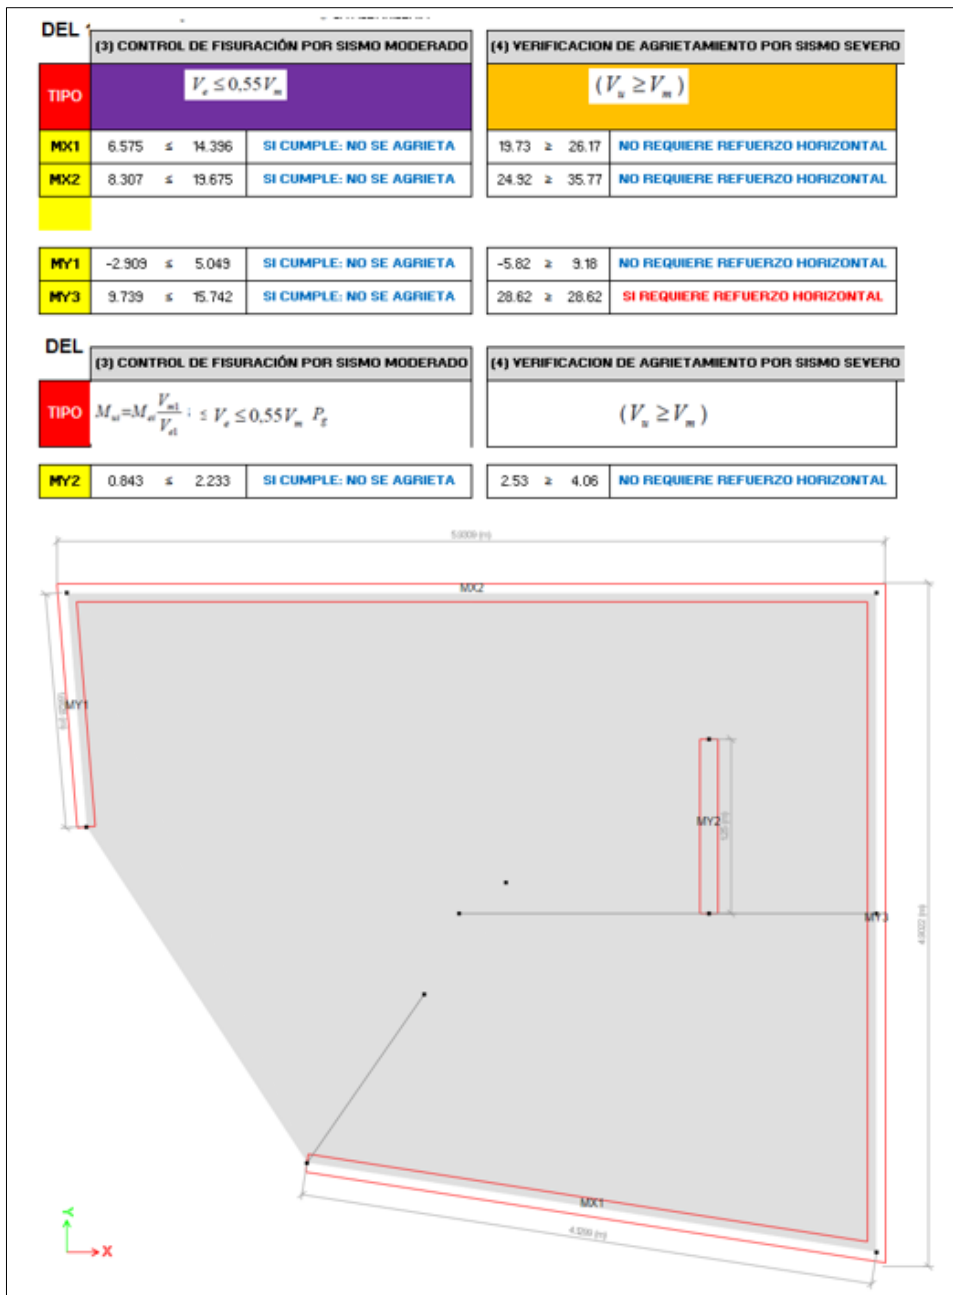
Control de fisuración por sismo severo y moderado de la vivienda 03
